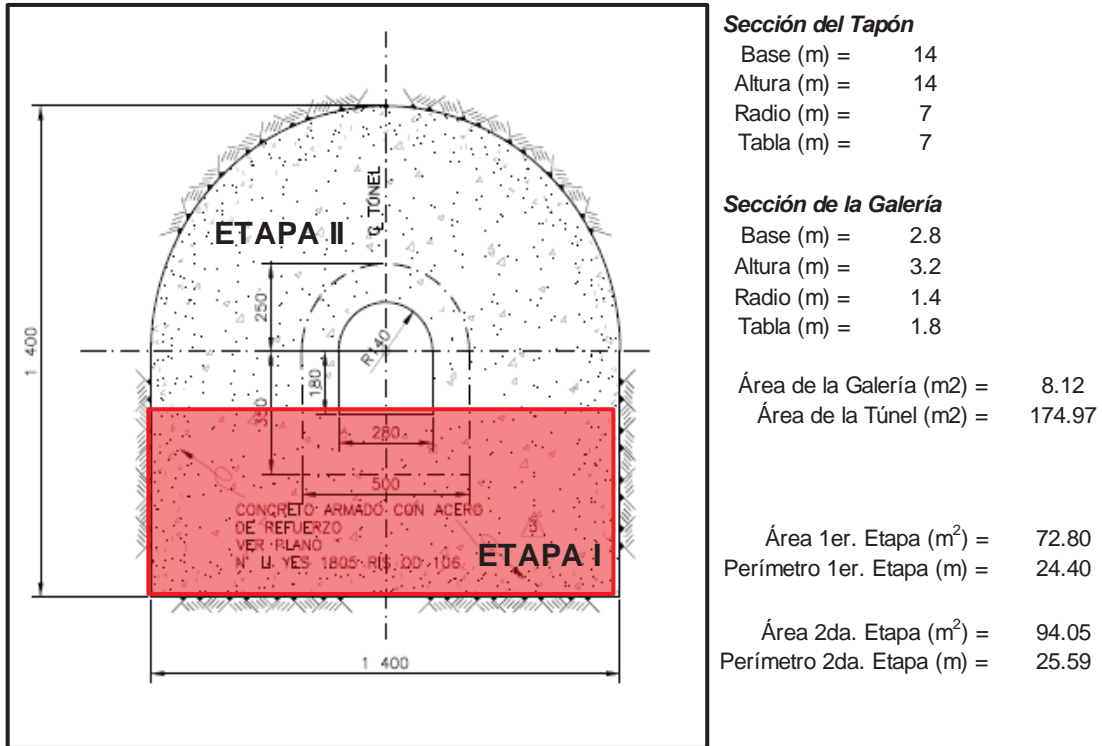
Etapas de Construcción para el Tapón Túnel 1
